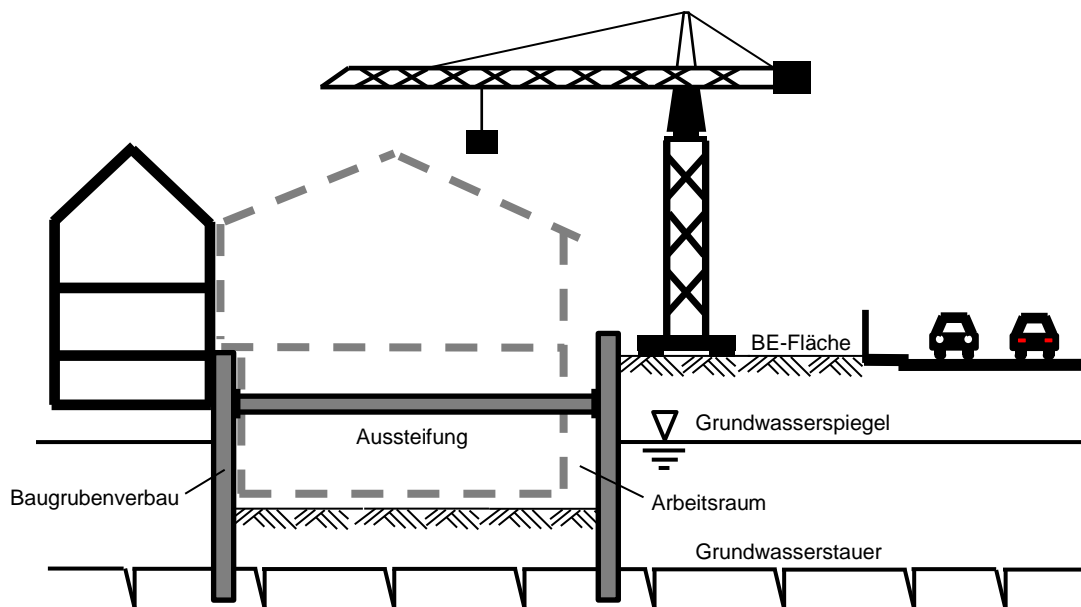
Ausgesteifter Baugrubenverbau mit Einbindung in den Grundwasserstauer, Baustelleneinrichtungsfläche auf bauherrneigenem Grundstück, Verbau zum Teil Bestandteil des Gebäudes
